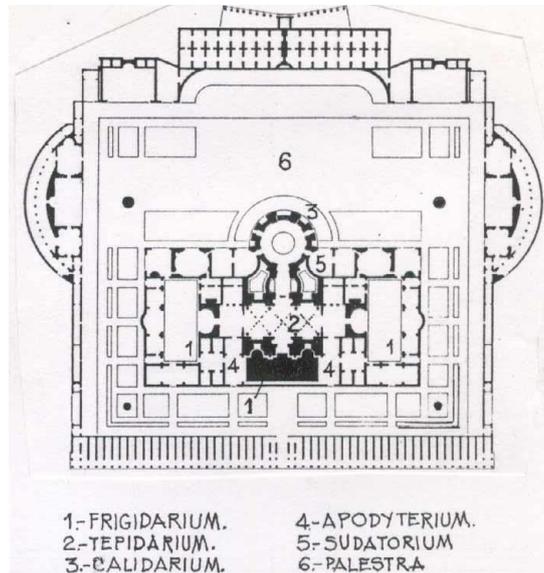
Planta baixa arquitetônica da Terma Caracala.
